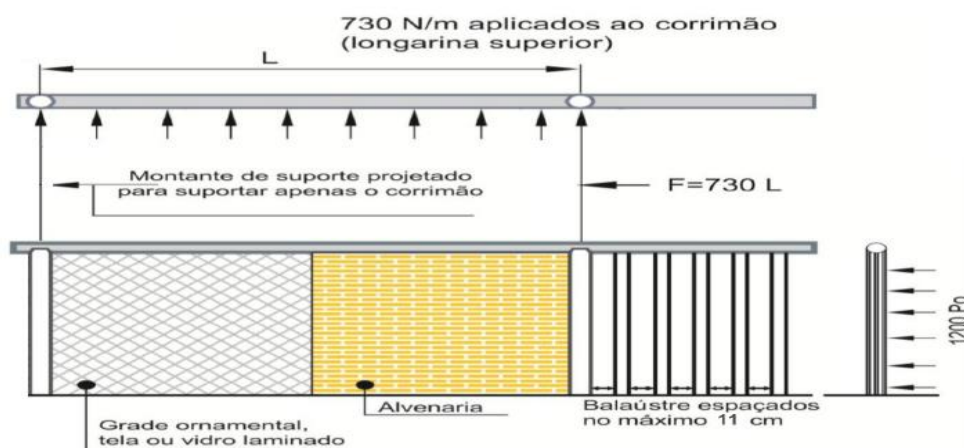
Pormenores construtivos da instalação de guardas e as cargas a que elas devem resistir
